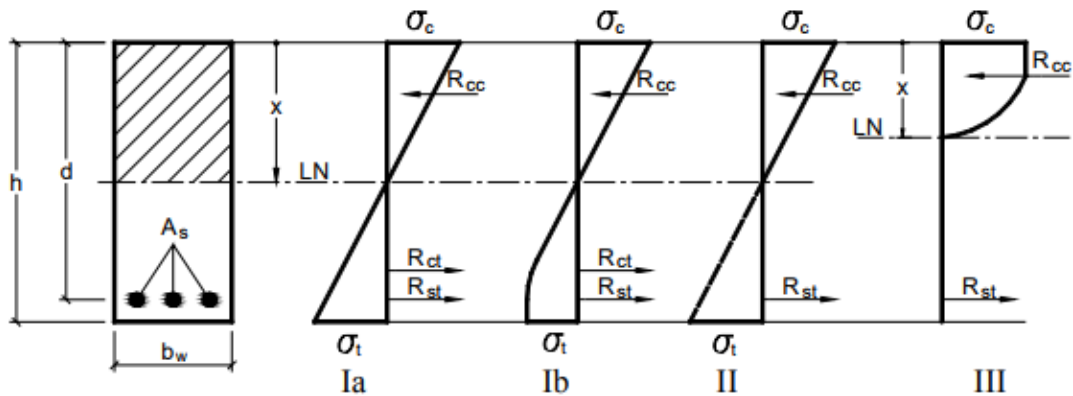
Evolução fissuração de uma viga com aumento de carregamento
